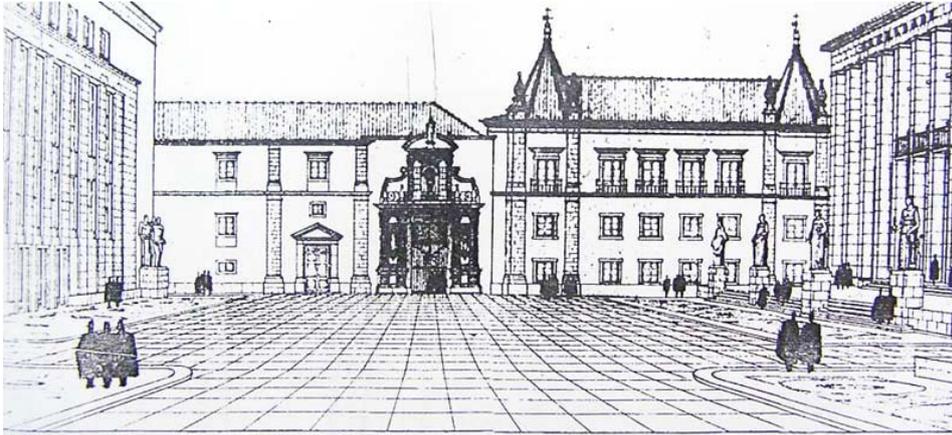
Desenho da Praça da Porta Férrea com o seu pavimento.
